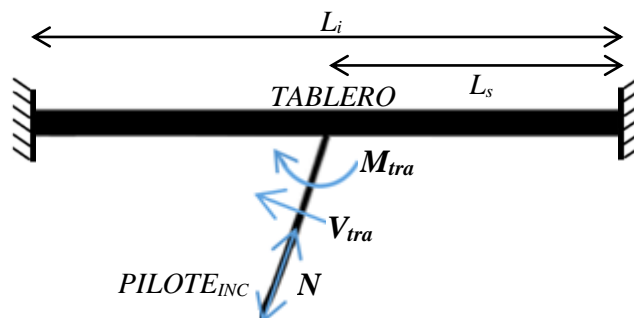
Conexión aislada de estructura con sistema de apoyos de empotramiento.
